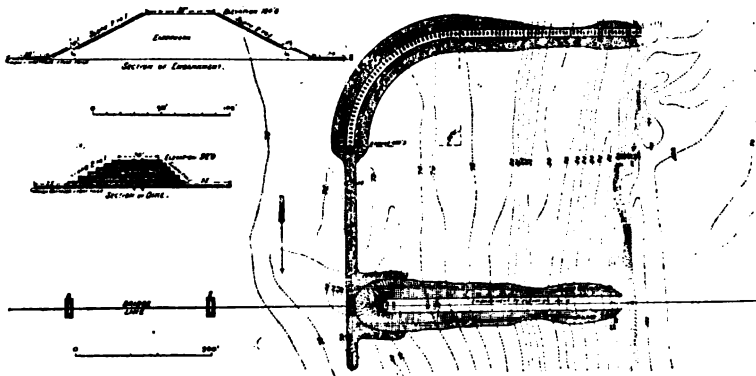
Pont des Marchands. — Coupes et Plan des digues.
